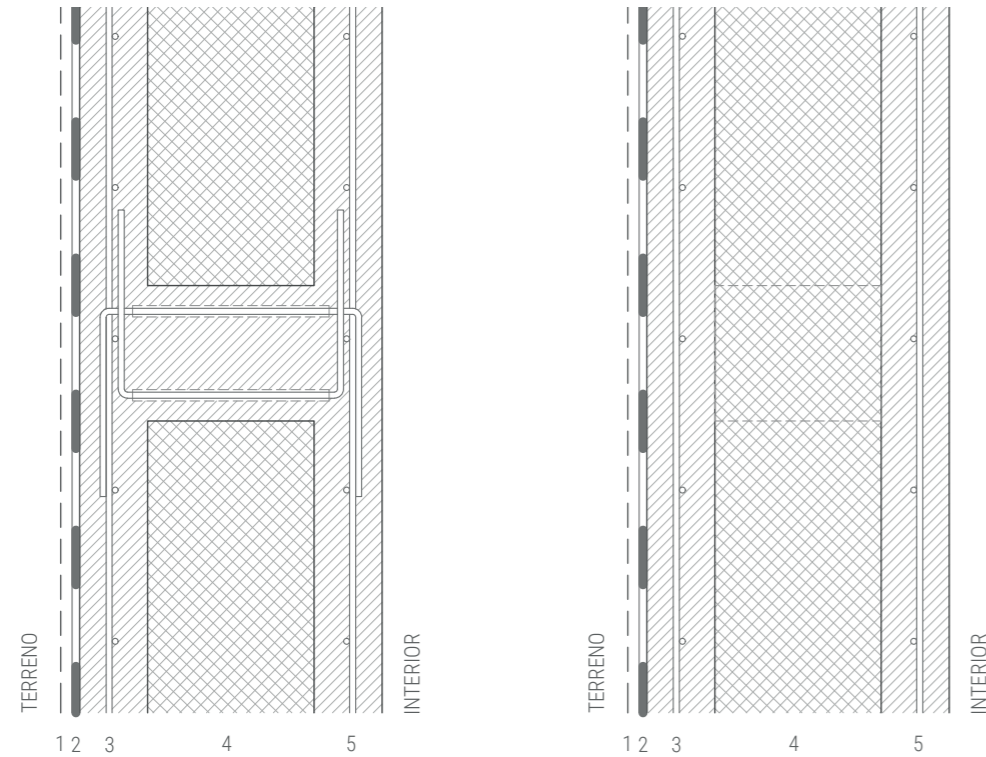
Detalle [muro en contacto con el terreno] E1:10
